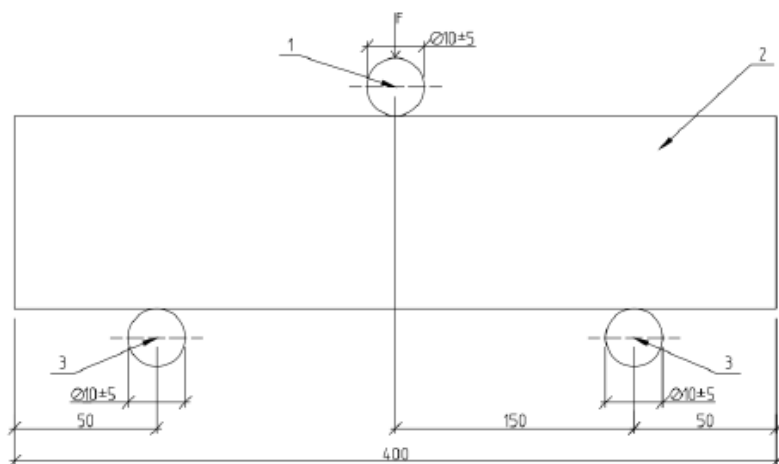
Схема испытания балки на изгиб 1 – Нагрузочный элемент; 2 – образец-балка; 3 – опора.
